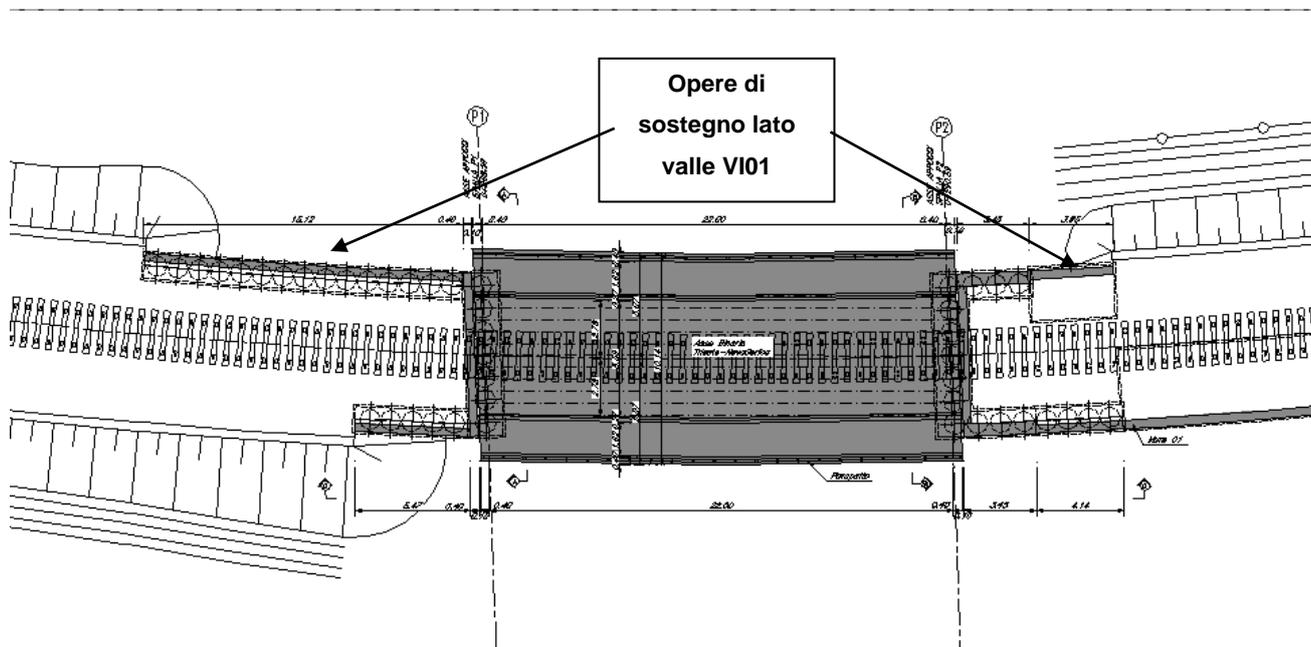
Planimetria con ubicazione dell'opera di sostegno lato valle.
